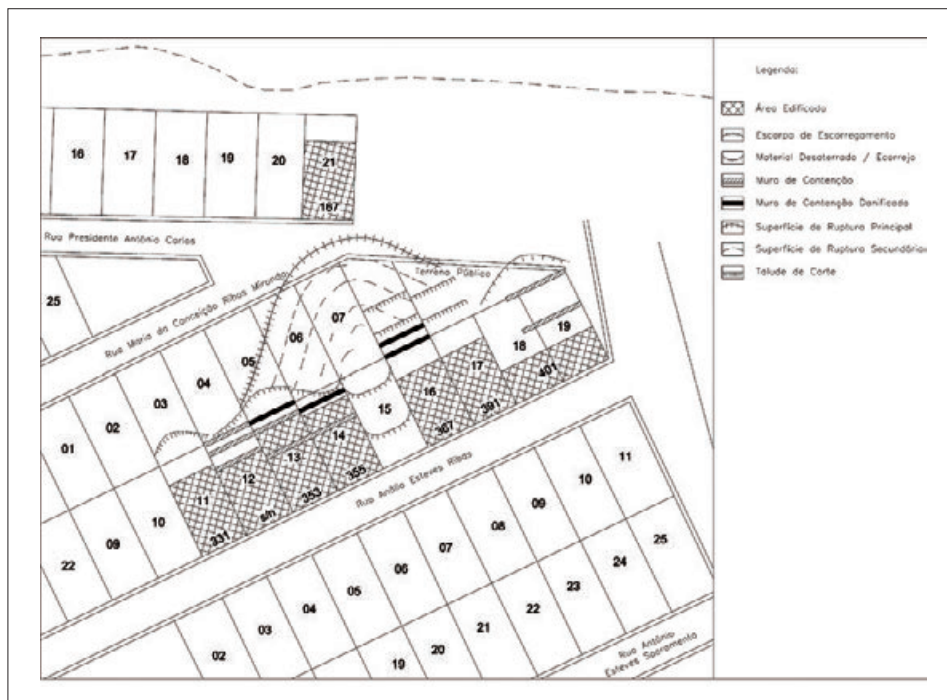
Planta esquemática do local do acidente (Figura do Relator)
